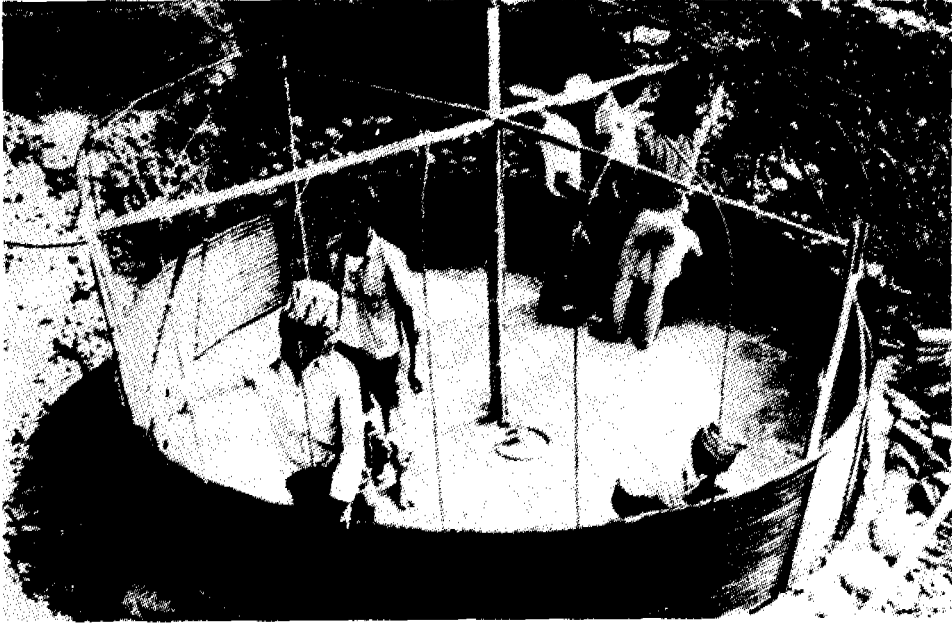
Construcción de tanque de ferrocemento empleando tubería plástica como molde interior, Nepal, 1986.
